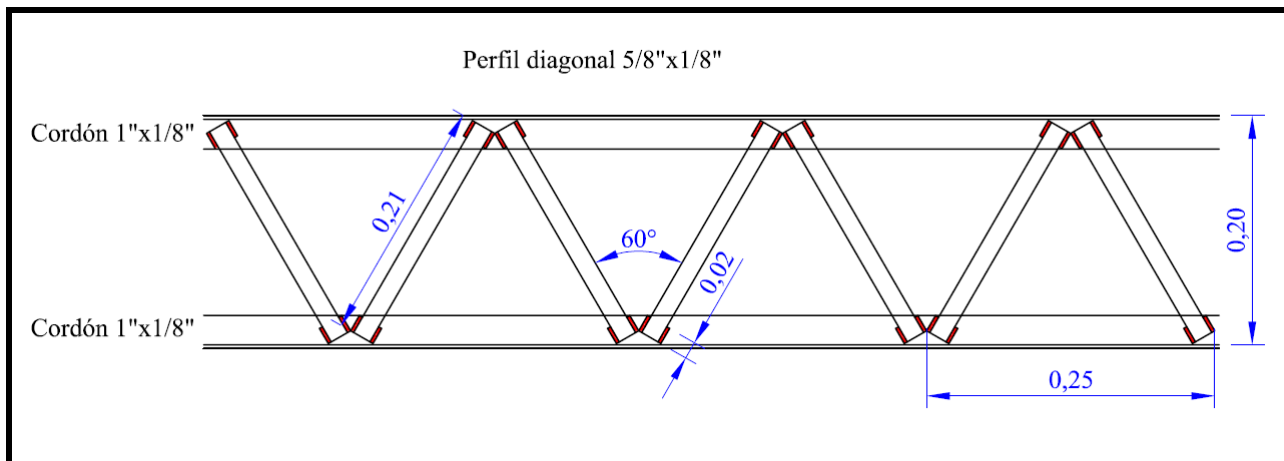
Detalle unión soldada diagonales-cordones.
